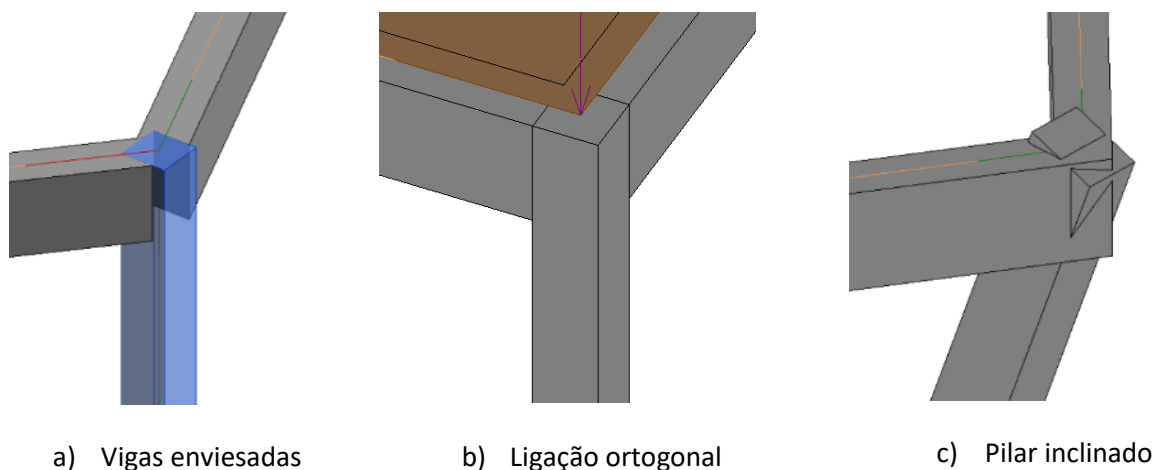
Exemplos de Ligação entre vigas e pilares
